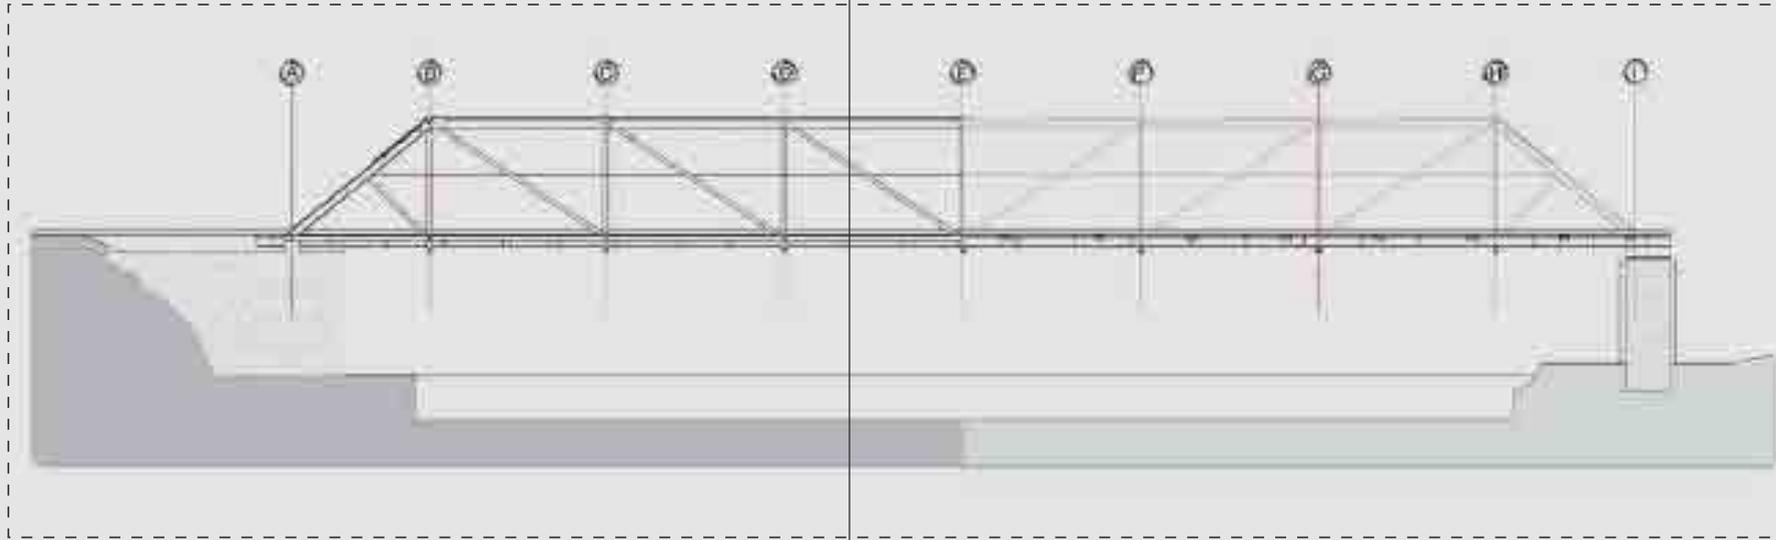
Corte - Fachada de puente de armadura metálica, Puente Araujo en Cúcuta
